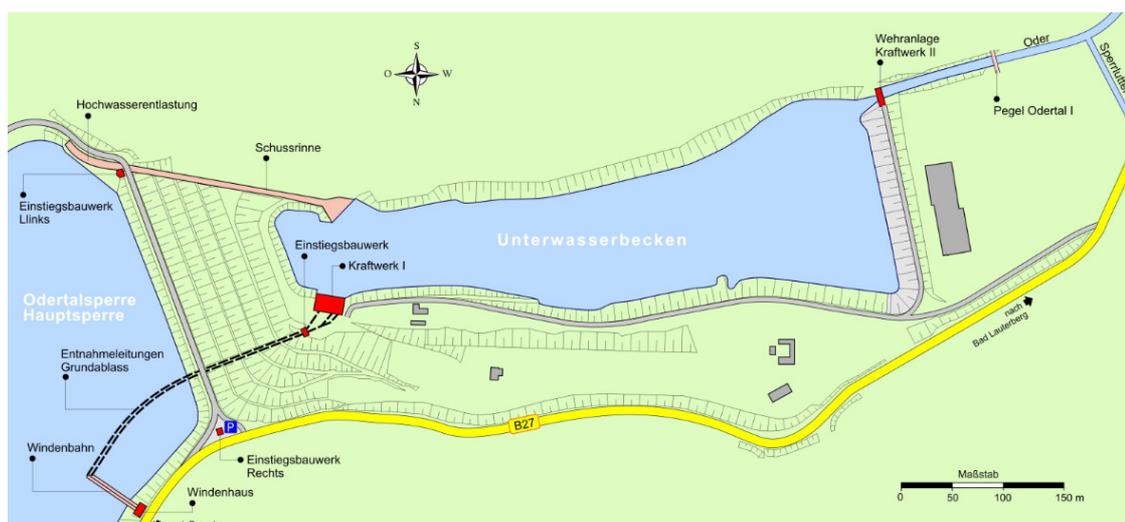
Odertalsperre Unterwasserbecken Lageplan
